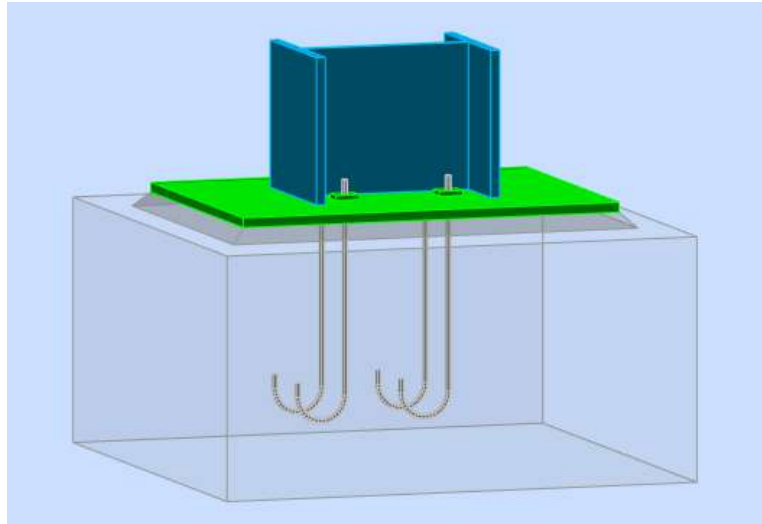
« Vue d'assemblage pied de poteau fait par Robot »
